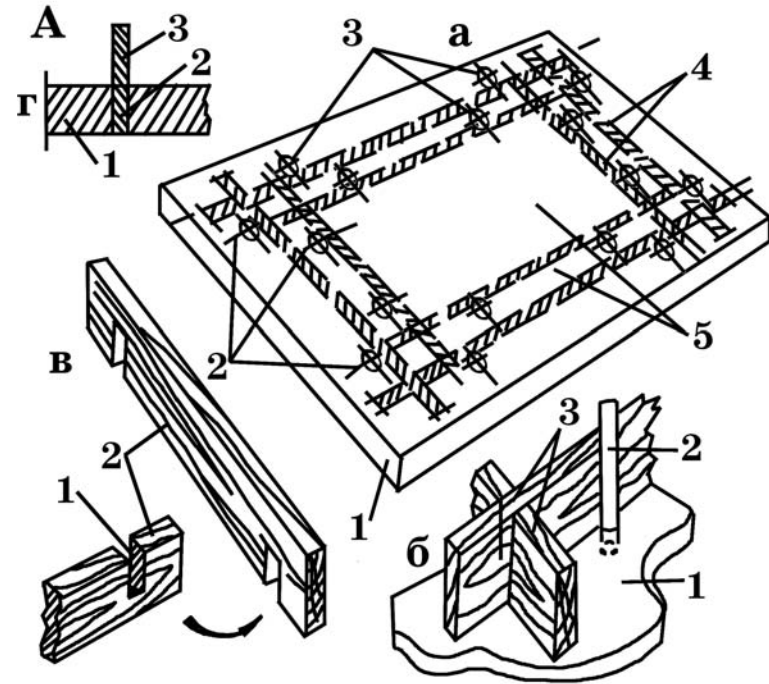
Технология изготовления закладных плит-брикетов. А – конструкция опалубки: а – основание опалубки: 1 – металлическая, деревянная плита; 2 – оси штырей-стопоров; 3 – отверстия для установки штырей-стопоров; 4 – бортовые доски; 5 – места укладки раствора; б – узел крепления бортовых досок опалубки: 1 – плита основания опалубки; 2 – штырь-стопор; 3 – бортовые доски; в – элементы опалубки: 1 – проушина; 2 – доска (бортик); г – узел соединения штыря с плитой основания: 1 – плита основания; 2 – штырь-упор; 3 – бортовая доска.
